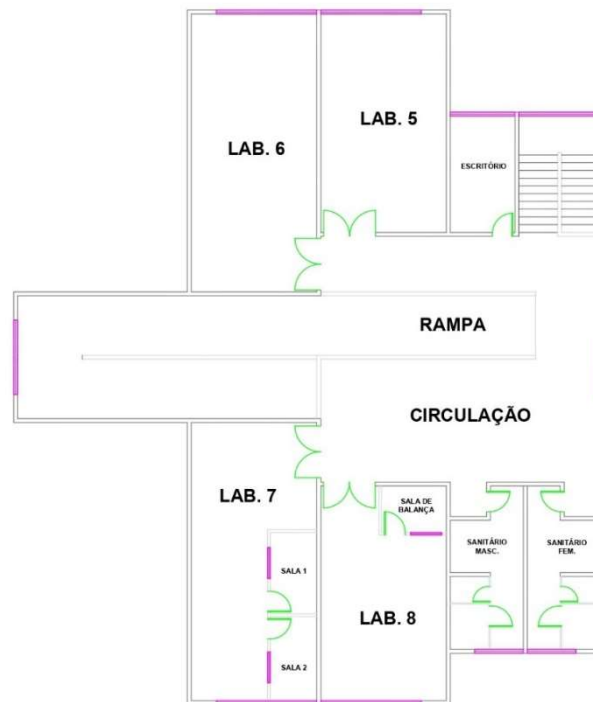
Planta baixa simplificada do pavimento térreo do C-Labmu
